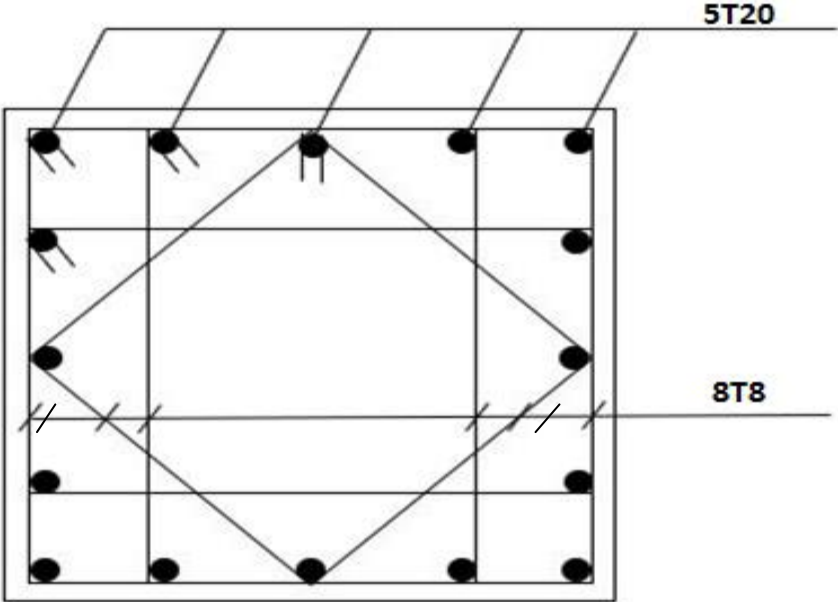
Schéma de ferrailage du poteau 65×65
